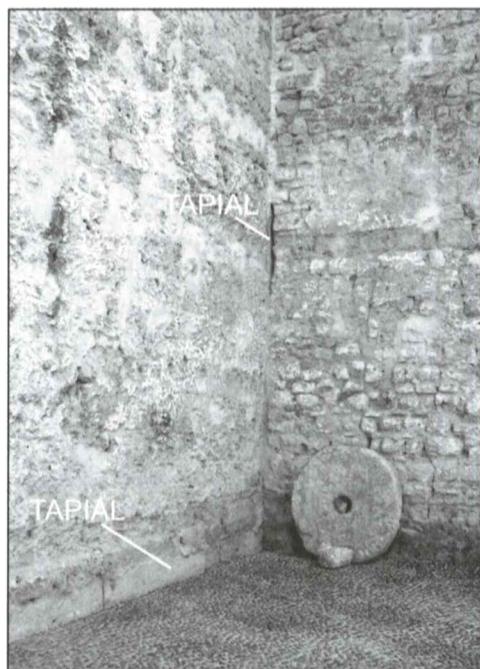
Muralla primitiva de tapial con torre adosada (siglo XIV), forrada de sillería (siglo XV) tras el picado del tapial original. La piedra de molino corresponde a uno aceitero construido junto a las murallas (siglos XIX-XX).
